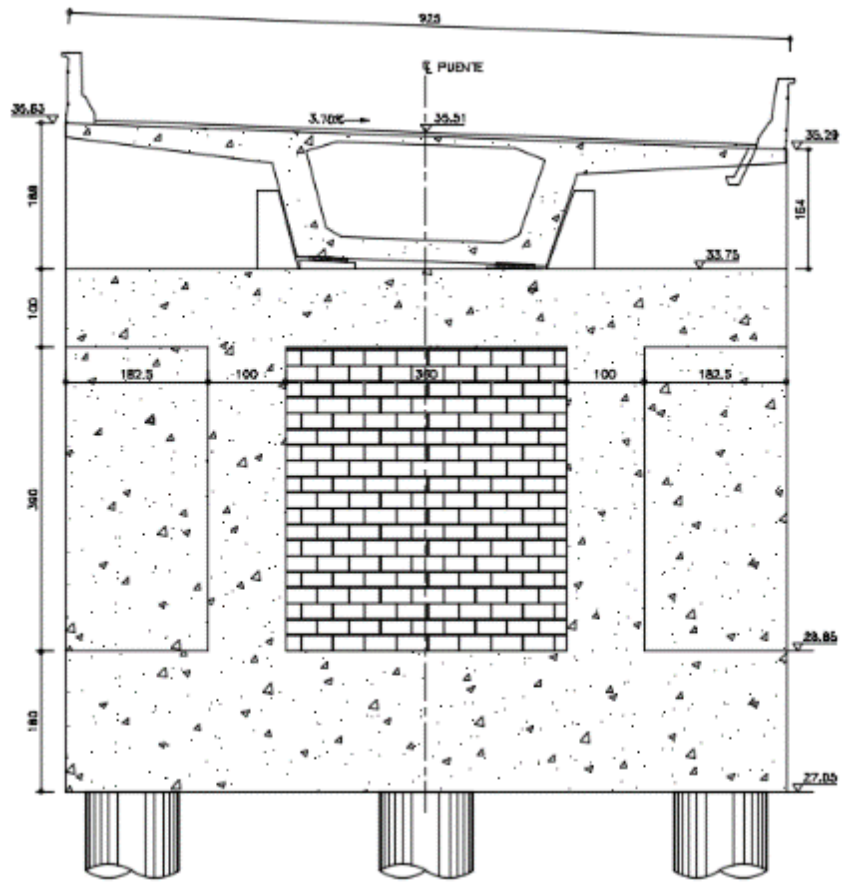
Geometría apoyo eje 1 – Puente Vía a Minca
